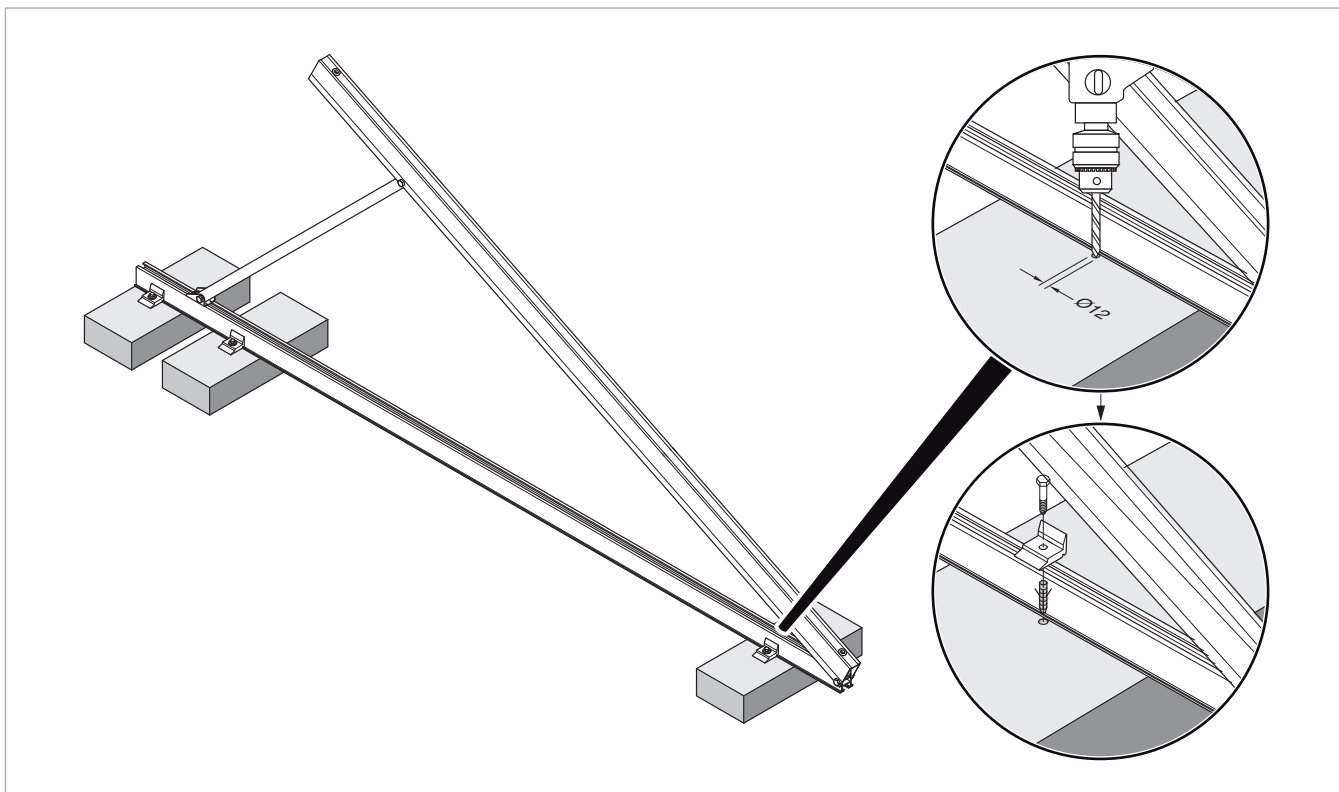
montagem do suporte para telhado plano sobre pedra de betão
